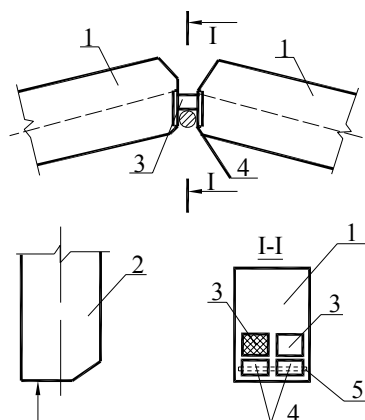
Конструкция конькового шарнира [11]: 1 – ригель; 2 – стойка; 3 – центрирующая прокладка; 4 – отрезки труб; 5 – стержень
